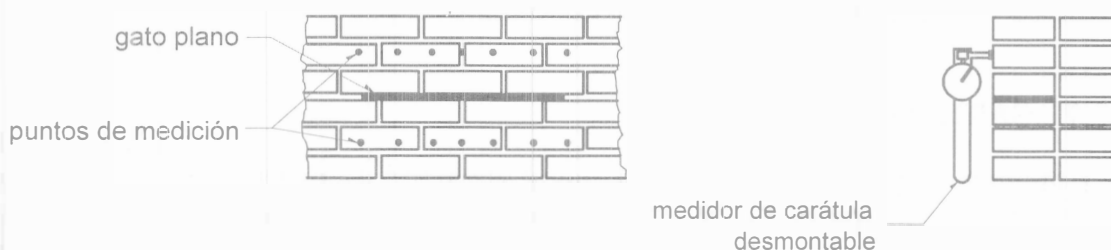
Dispositivo de prueba para la determinación in situ del estado de esfuerzos de compresión existente dentro de la mampostería.
